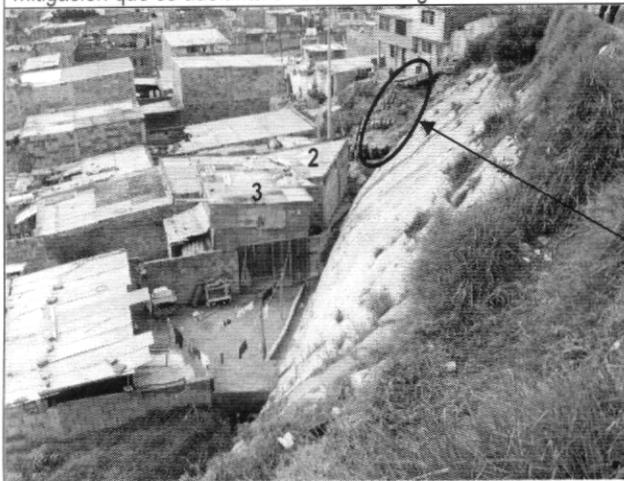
Viviendas localizadas en la parte baja del talud fallado
